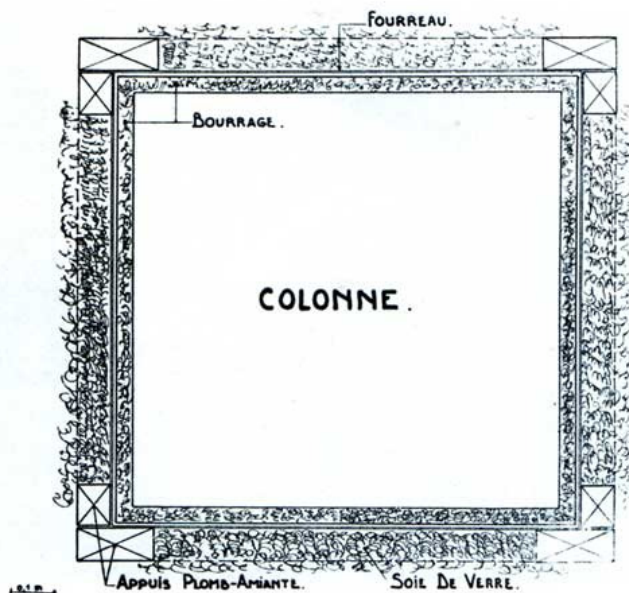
Disposition en plan des appuis élastiques d'un fourreau de colonne.
